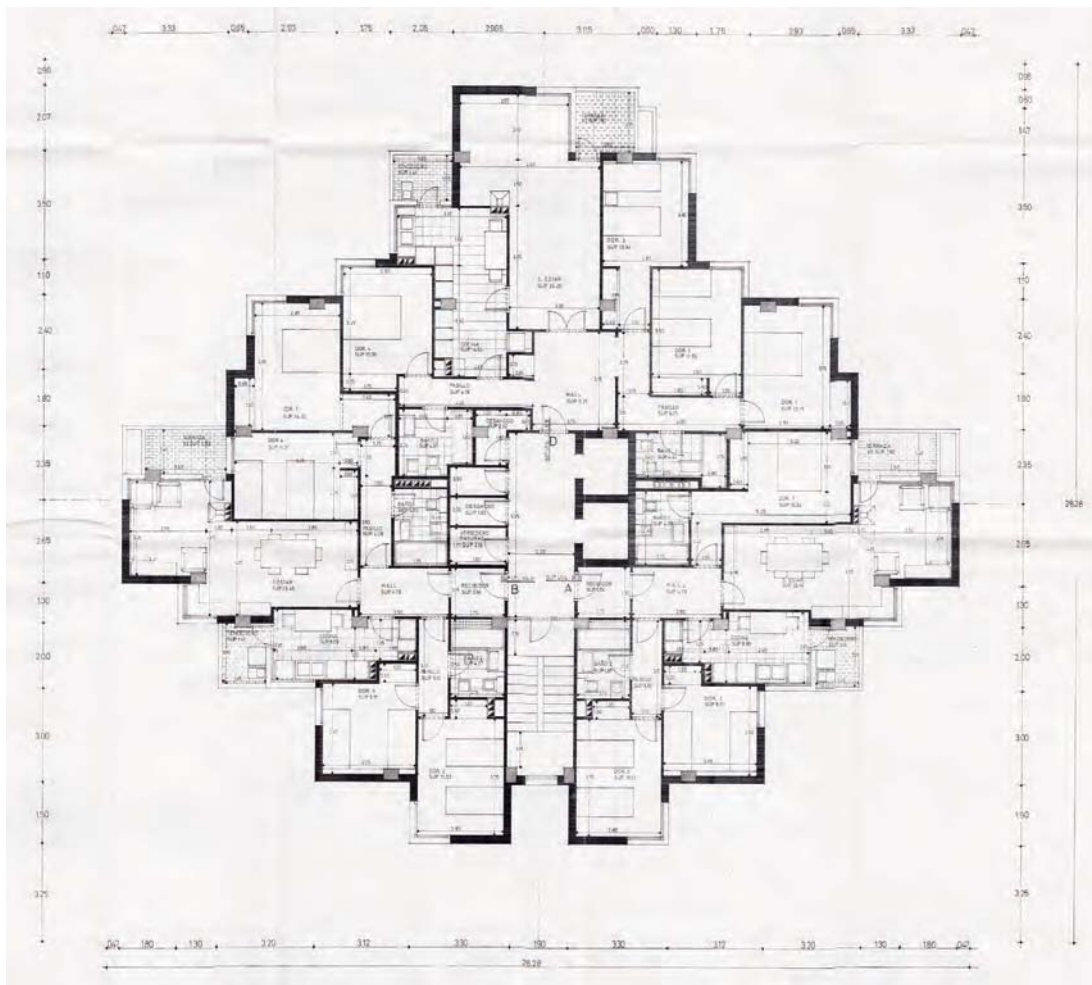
Planta tipo de las viviendas, edificio Tres Torres, Huesca, arquitectos: Alejandro Lansac y José Antonio Blecua. Plano de proyecto. Fotografía: Archivo Municipal de Huesca, 1974.
